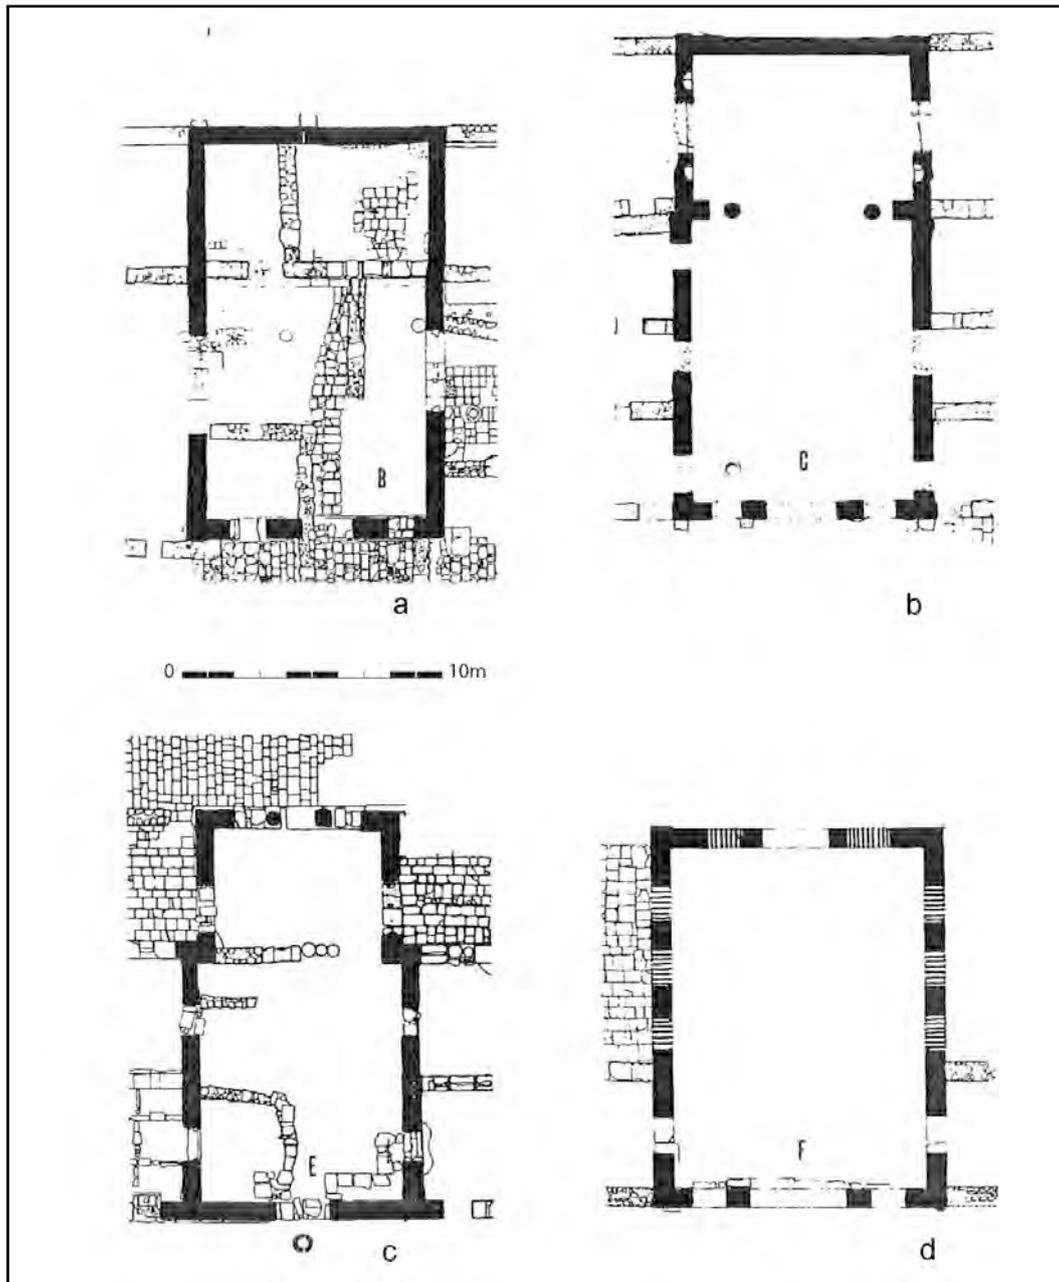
Planimetrie delle sale da banchetto a pianta rettangolare a doppio pilastro da Apamea, Siria.
